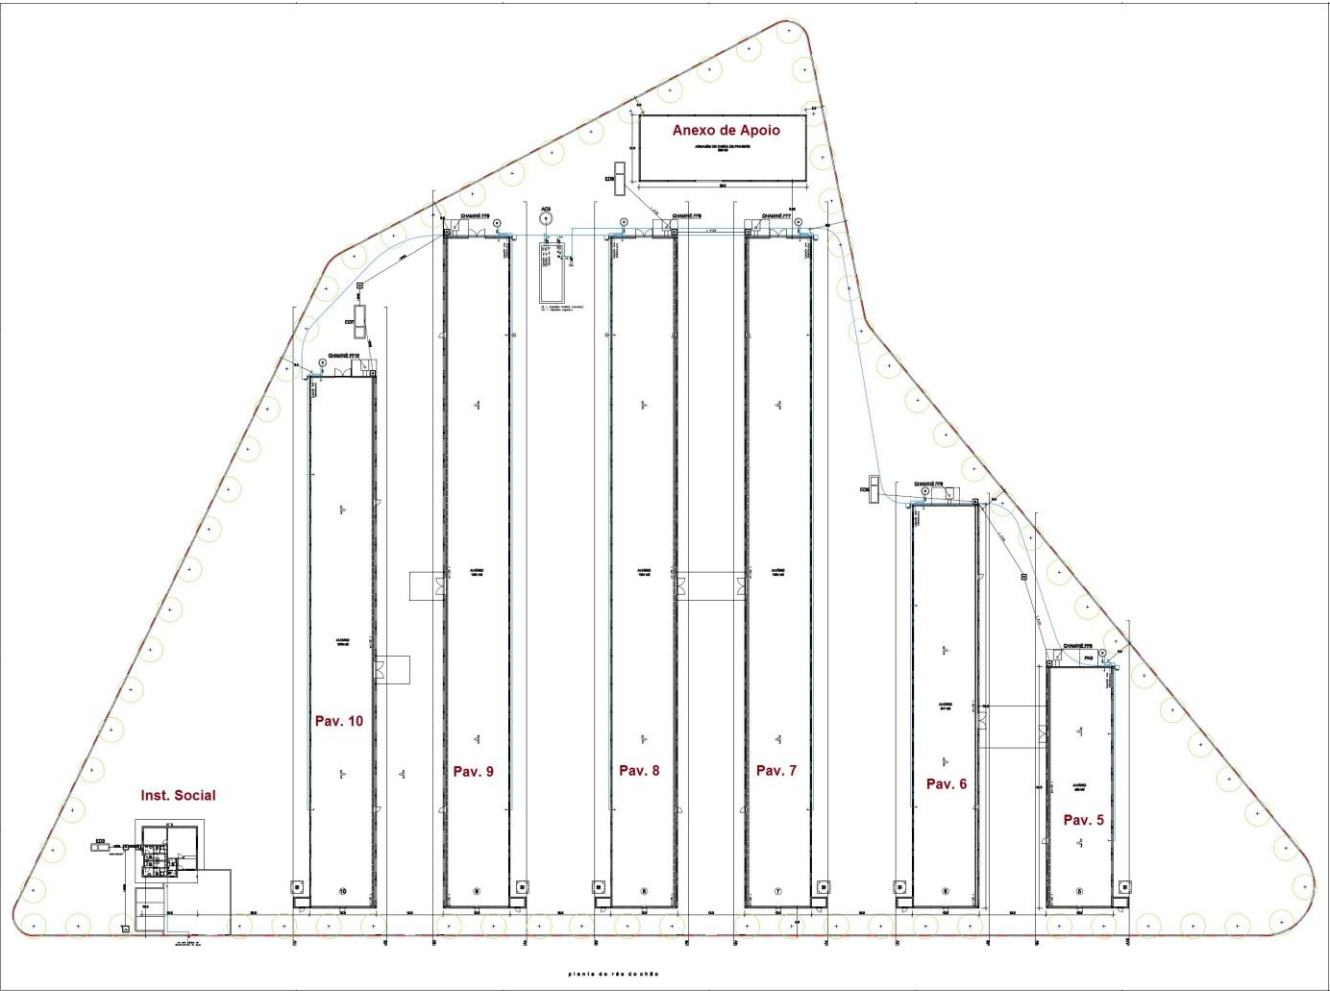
Planta esquemática do NP3: principais elementos edificados de produção e apoio (sem escala).
